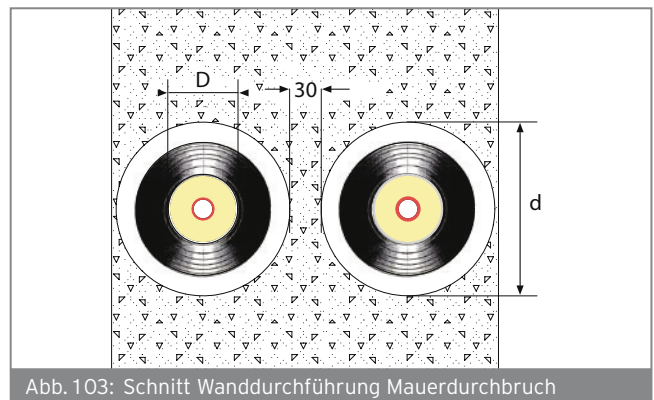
Schnitt Wanddurchführung Mauerdurchbruch
